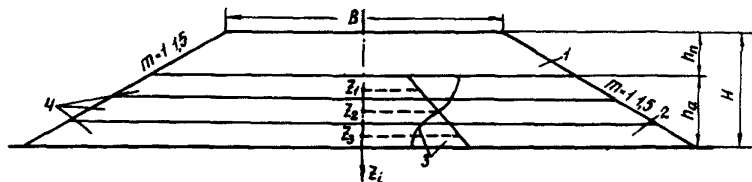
Расчетная схема для прогноза осадки: 1–неконсолидируемая (пассивная) зона насыпи  $h_n$ ; 2–то же, консолидируемая (активная)  $h_a$ ; 3–нагрузка от веса грунта неконсолидируемой зоны и собственного веса грунта консолидируемой зоны; 4–расчетные слои;  $z_i$  – координата середины слоя
